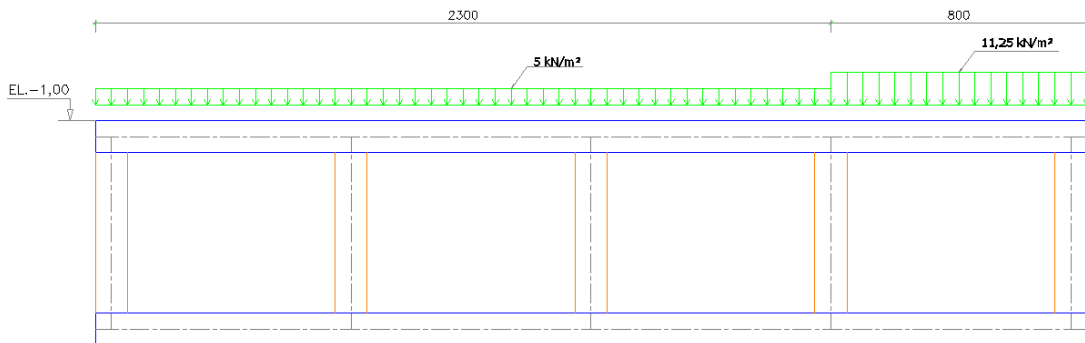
Esquema de carregamento de sobrecarga móvel – posição 1
